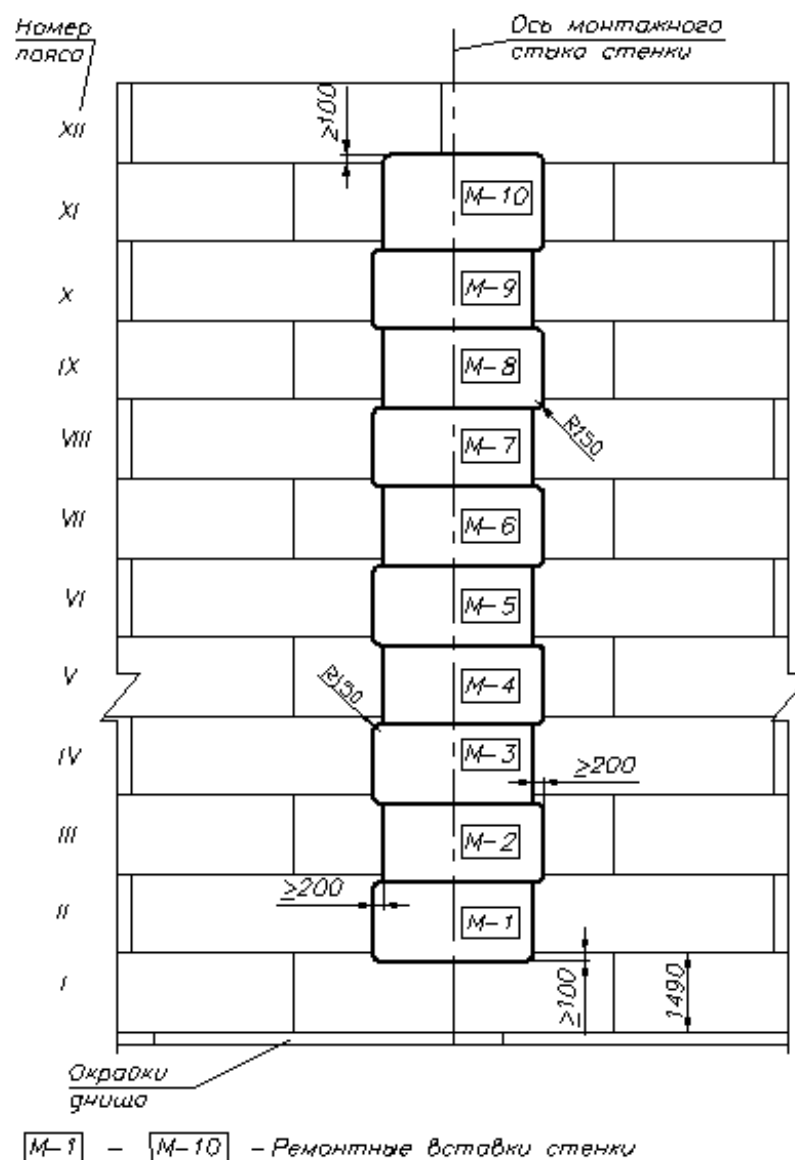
Схема ремонта стенки рулонного резервуара в зоне монтажного стыка
